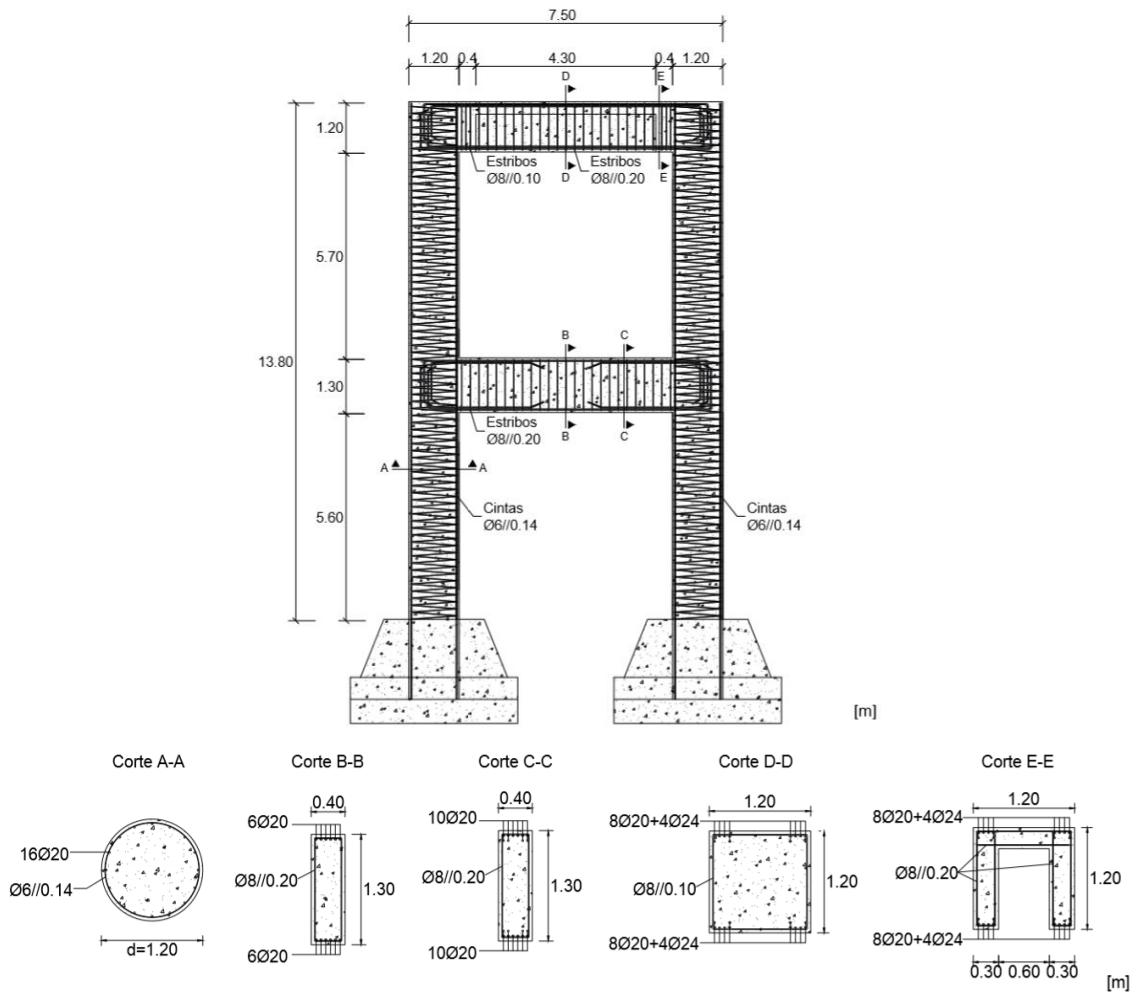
Geometria e pormenorização das armaduras do pórtico 12 (adaptado de *Paolacci et al.* [42])
